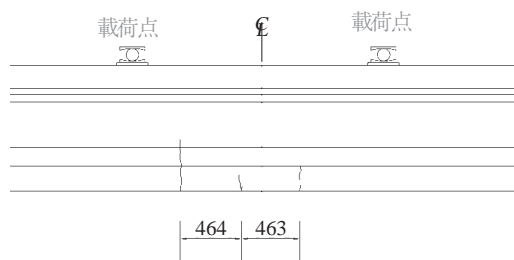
ひび割れ発生状況 (実規模試験体ケース A, 単位: mm)
